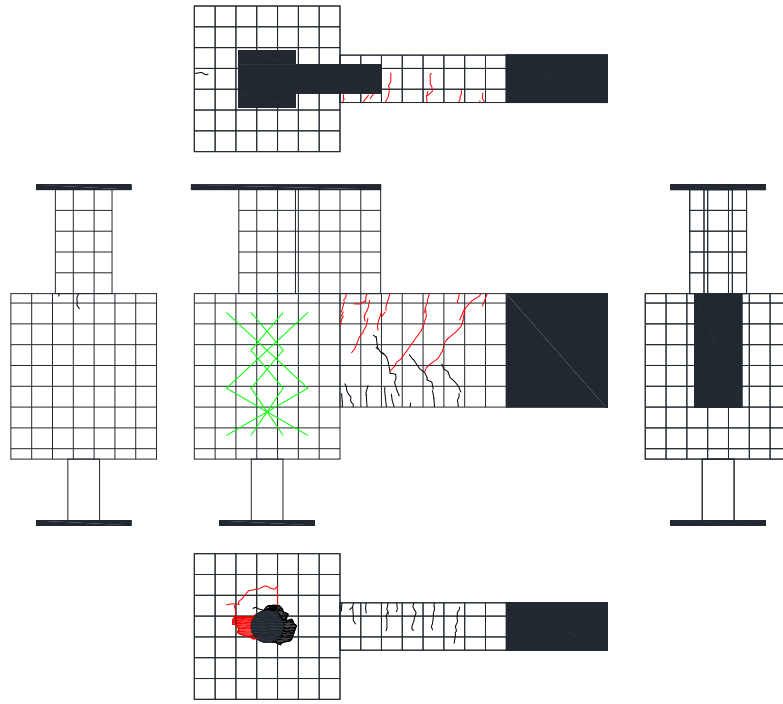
2. 3-37 試験体 DR-3 ひび割れ状況 (5Cycle)
